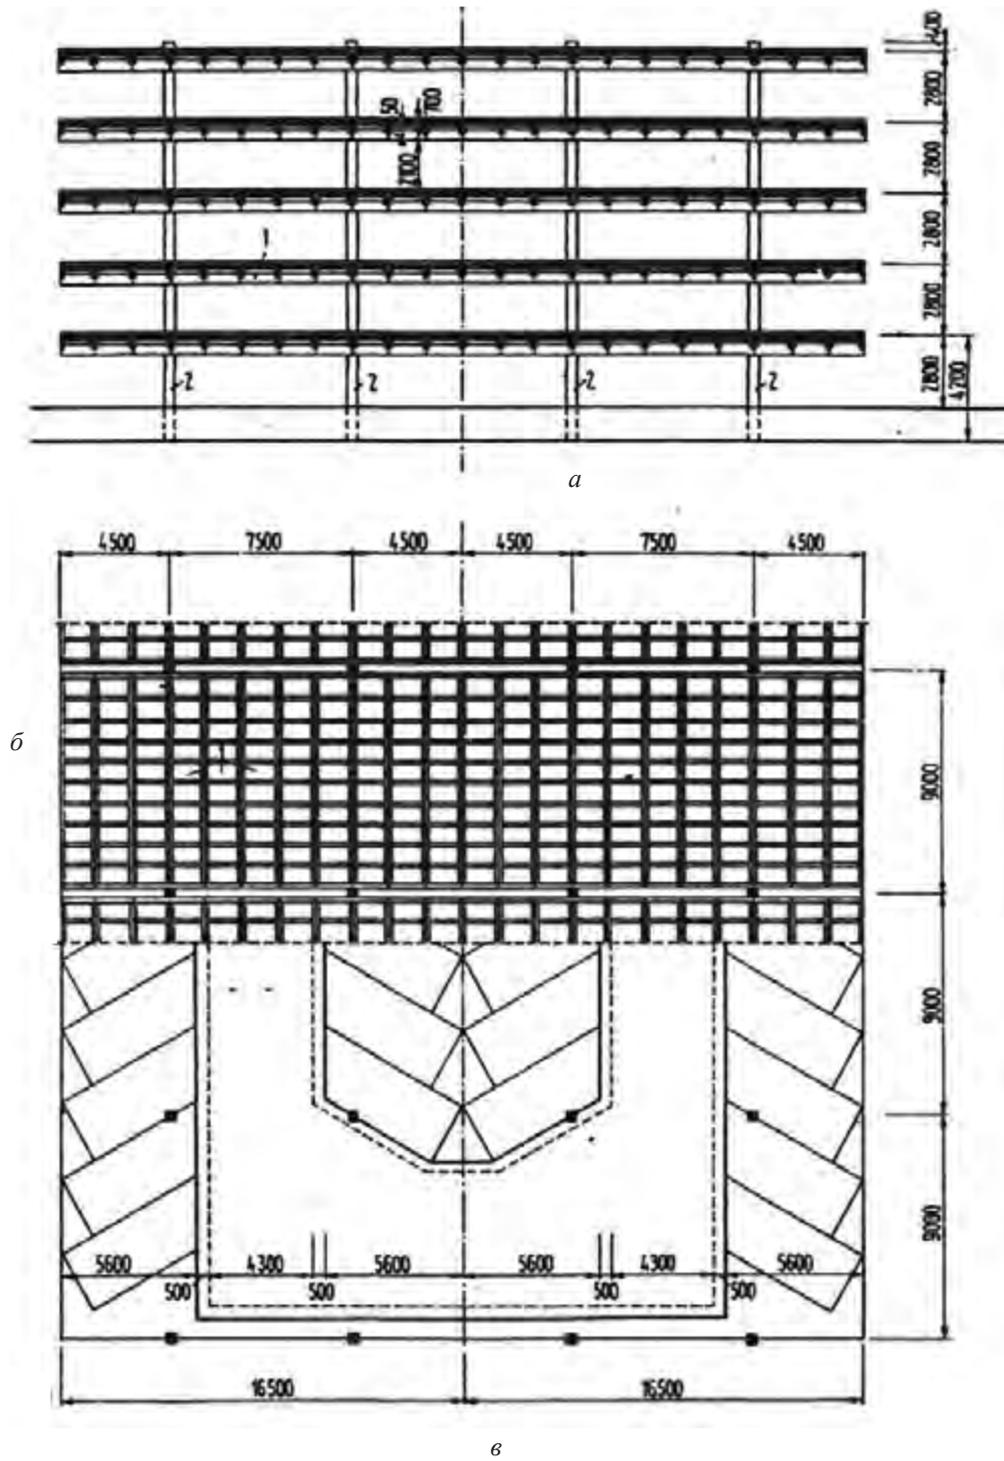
Варианты косоугольной расстановки автомобилей: *a* — схема разреза; *б* — план раскладки плит перекрытия, несущих балок и ригелей; *в* — план: 1 — ребристые плиты перекрытия; 2 — колонны
